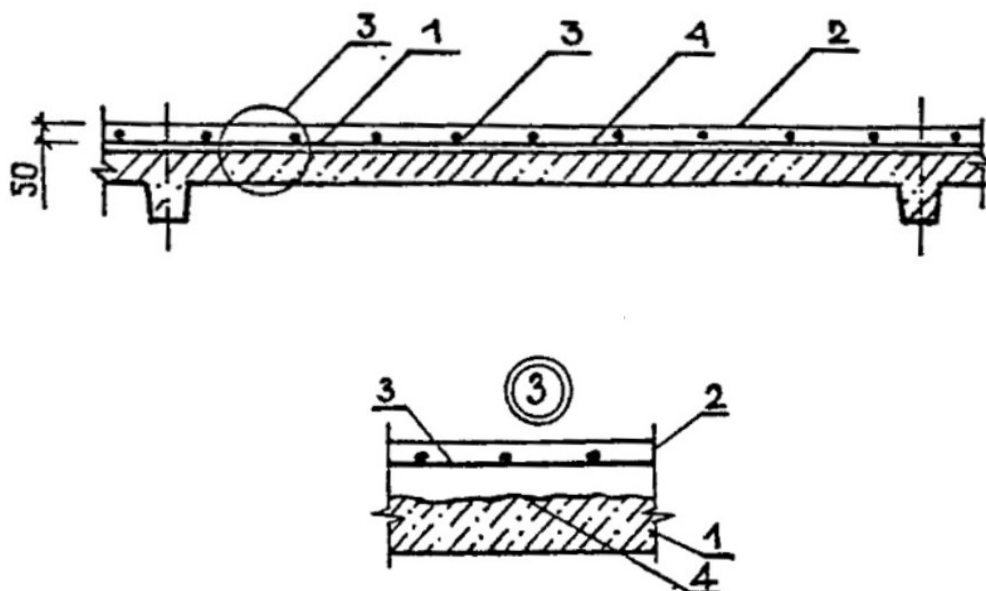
Збільшення несучої здатності плити перекриття нарощуванням зверху з додаванням поверхі шорсткості: 1 – плита перекриття, яка підлягає підсиленню; 2 –шар бетону з моноліту; 3 – додаткова арматурна сітка; 4 – площина з'єднання бетону з плитою
